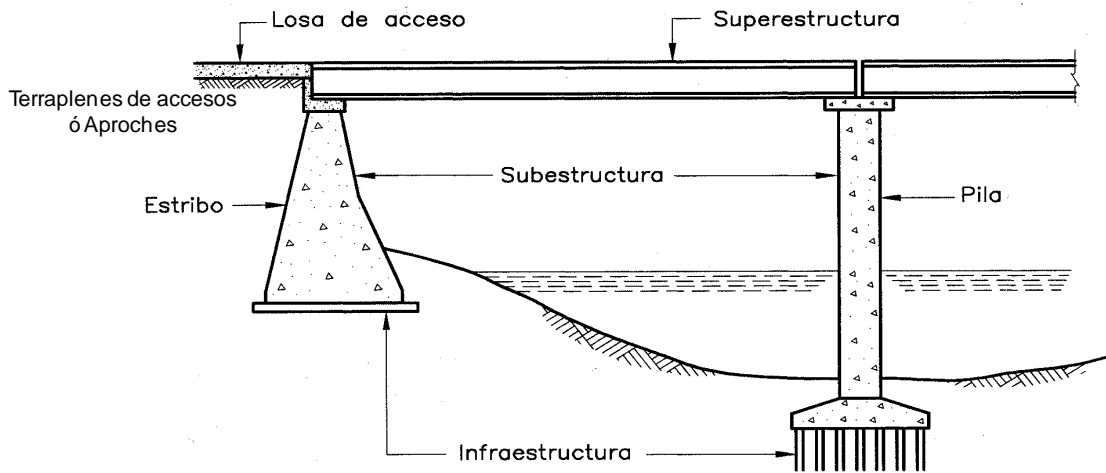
Partes que integran un puente, Elevación. Fuente: Tesis Puente Copalillo, Pág. 5.
